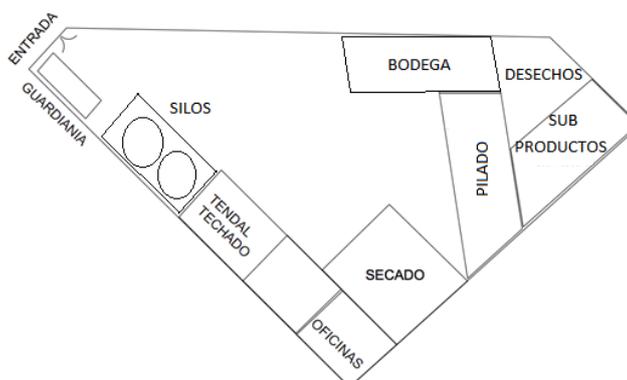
Plano de la piladora del pueblo Barranca
